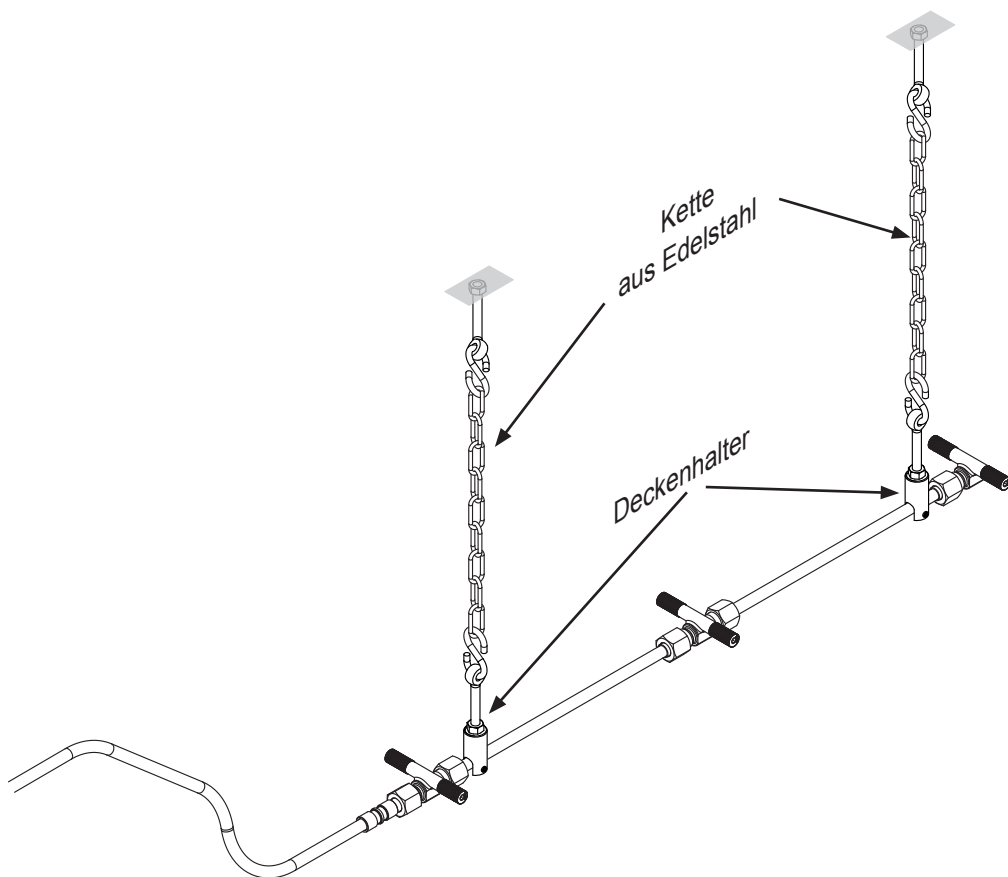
Deckenmontage des Verneblers Condair Vita Line
